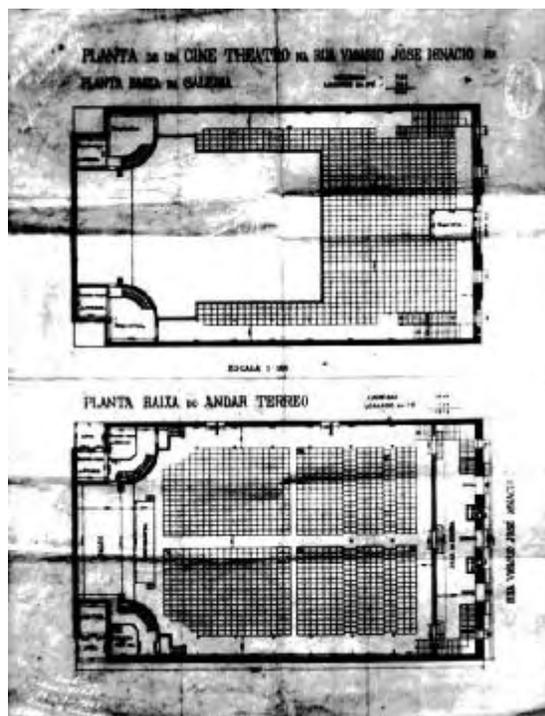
Cine Theatro Centenário, planta baixa pavimentos superior e térreo.
